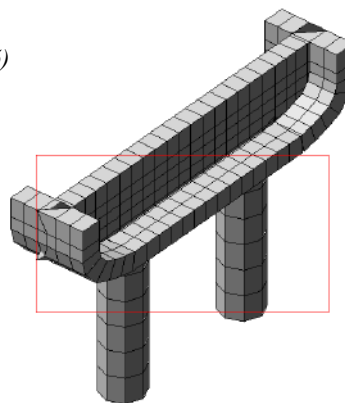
Схема опоры железобетонных конструкций типа ригеля (а);
